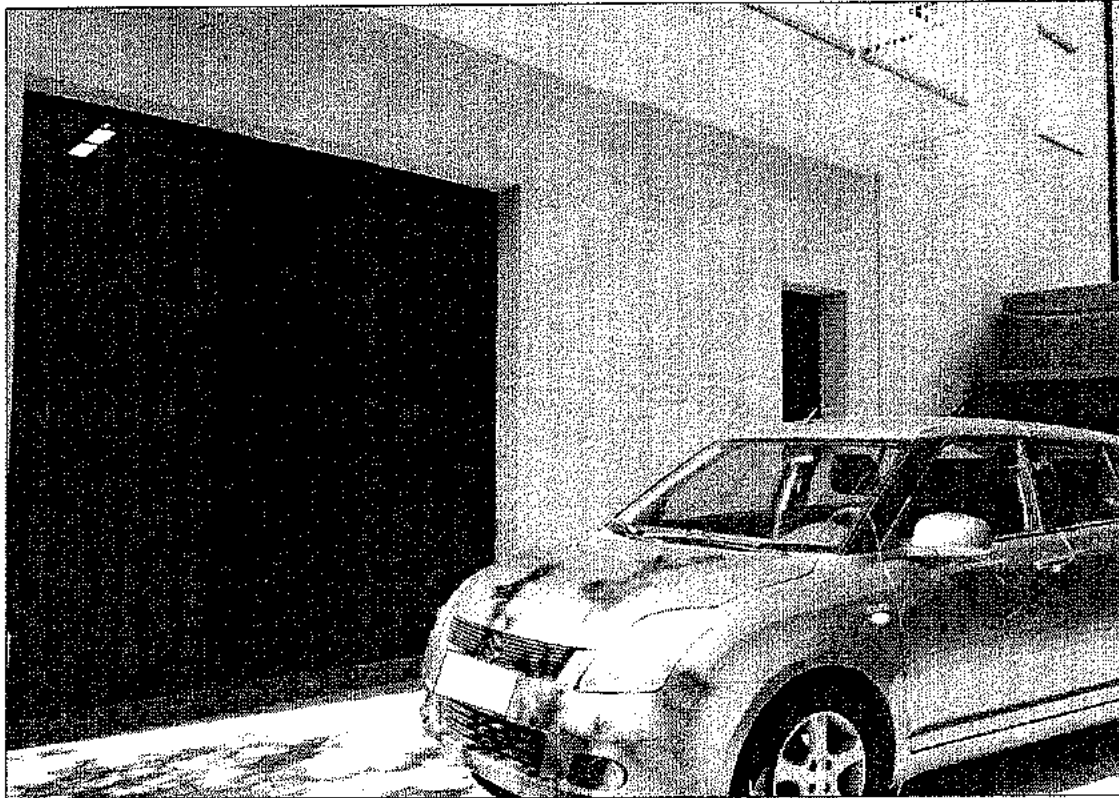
L'ingresso al locale autorimessa dall'area cortilizia
